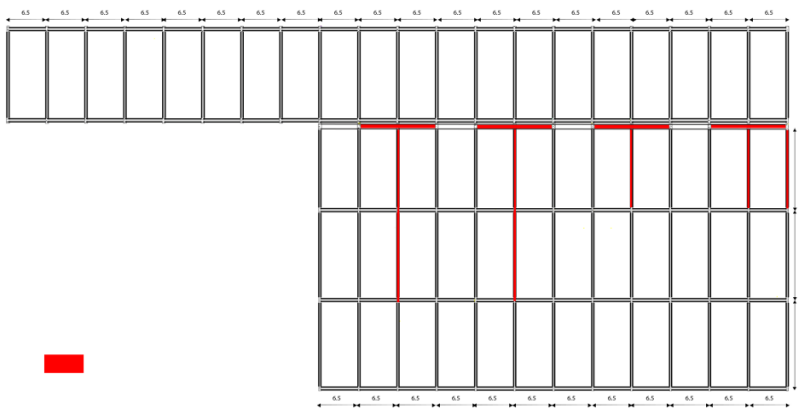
plan de modification de l'ancienne structure, Source : Auteur
